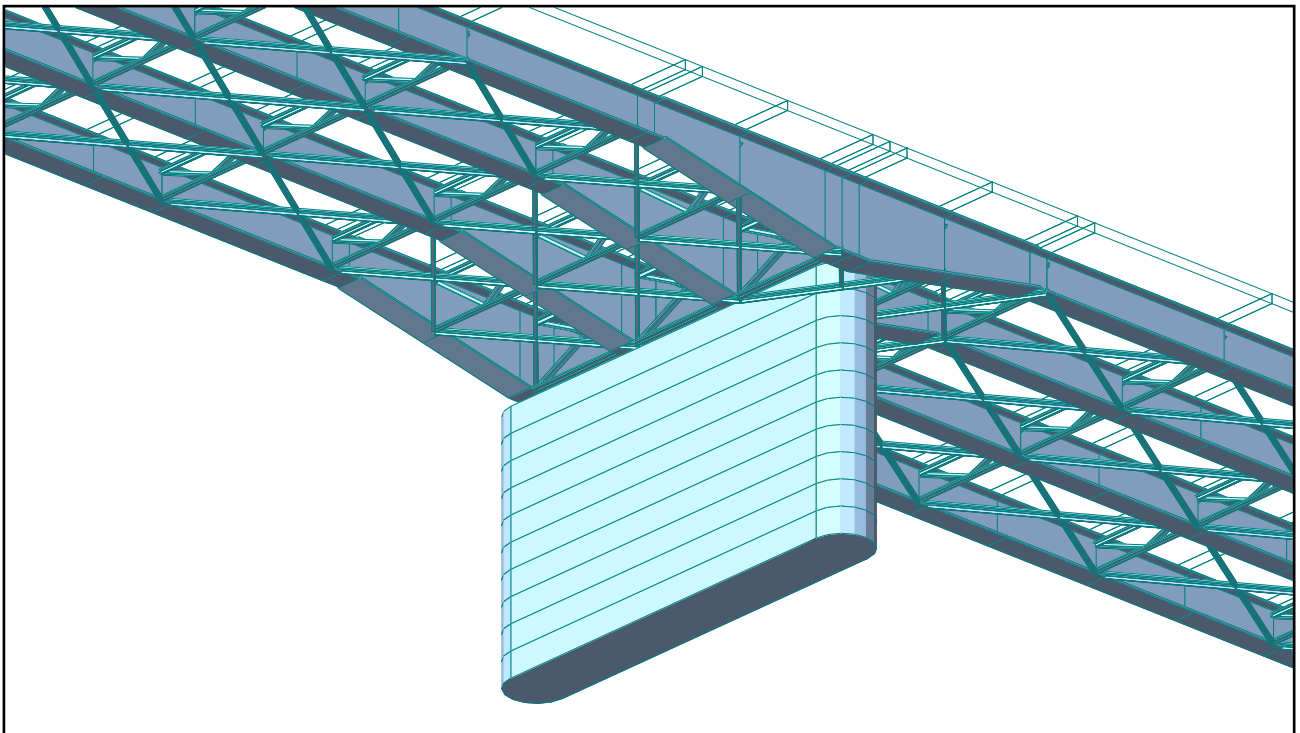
SCHEMA DI CALCOLO – PARTICOLARE SU PILA
